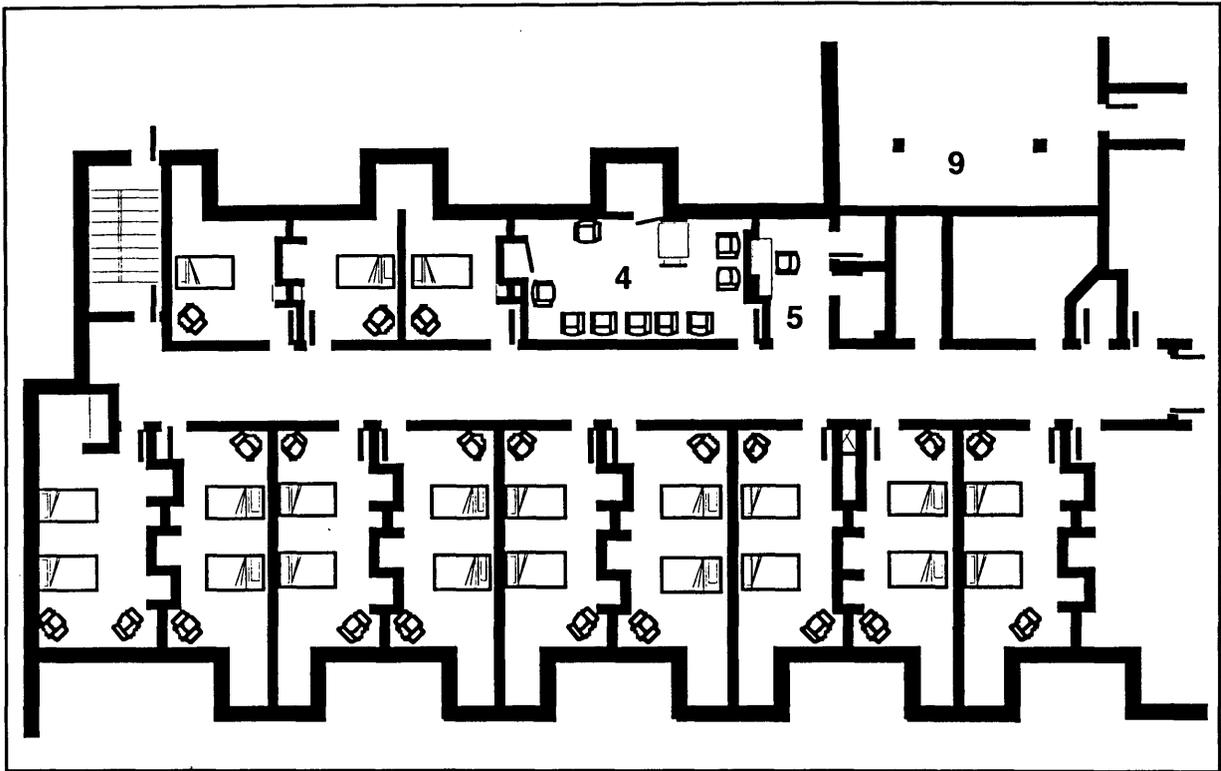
Salles de l'unité de vie du rez-de-chaussée
